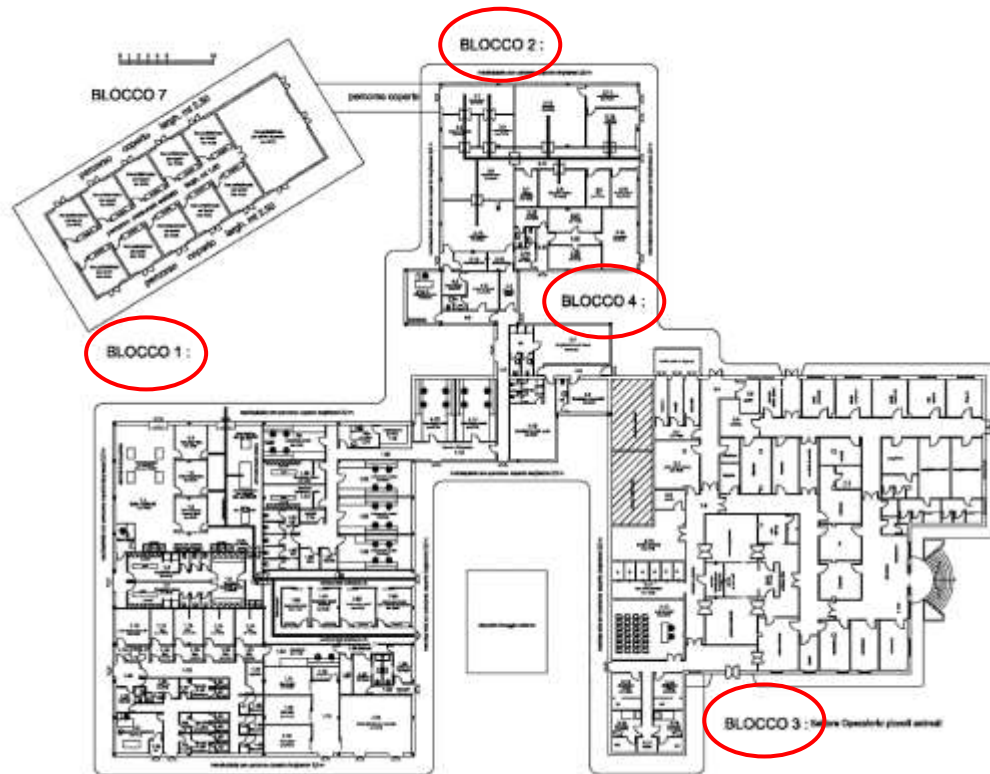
Vista in pianta complesso Frullone con indicazione Blocchi
